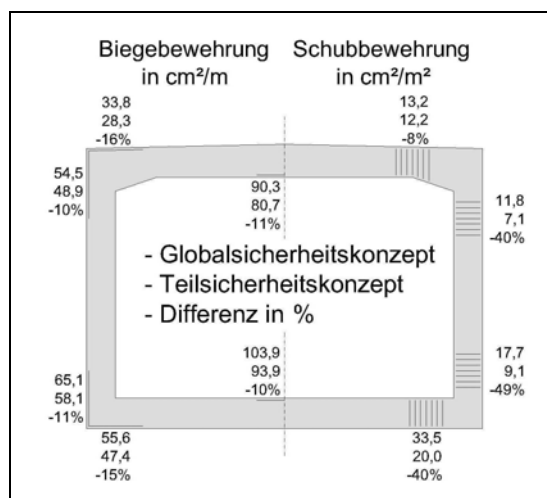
Tunnel in offener Bauweise, Bewehrung aus Nachweisen im Grenzzustand 1 B, ohne LF Brand
